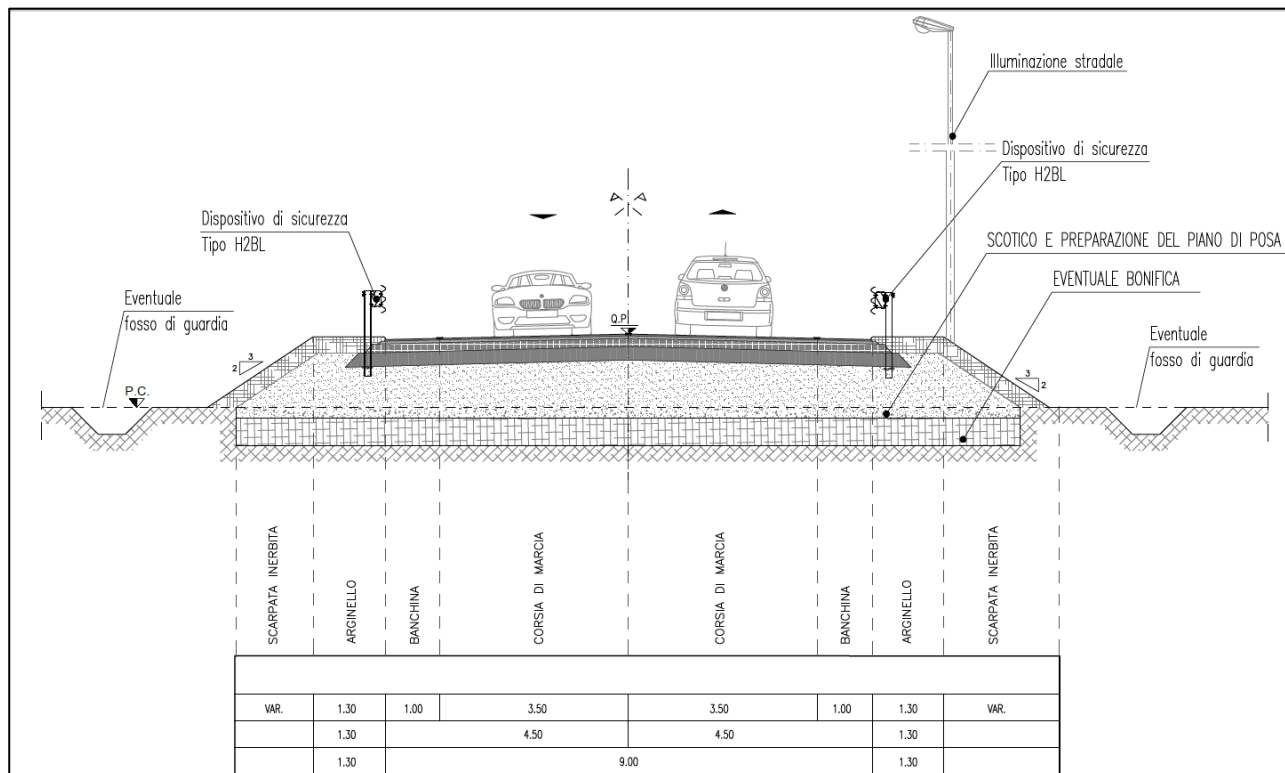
Sezione stradale rampa a doppio senso di circolazione
